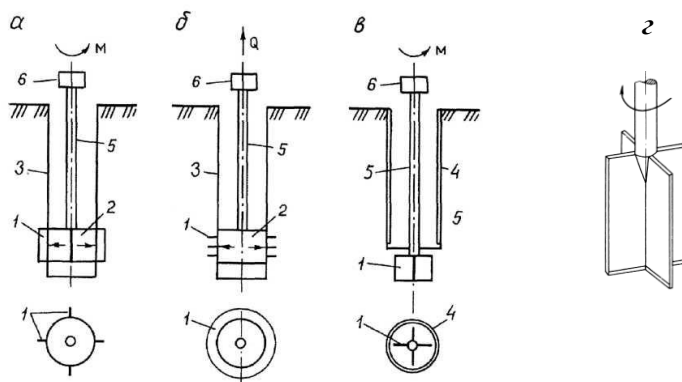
Схемы испытания грунта в скважинах на срез:
